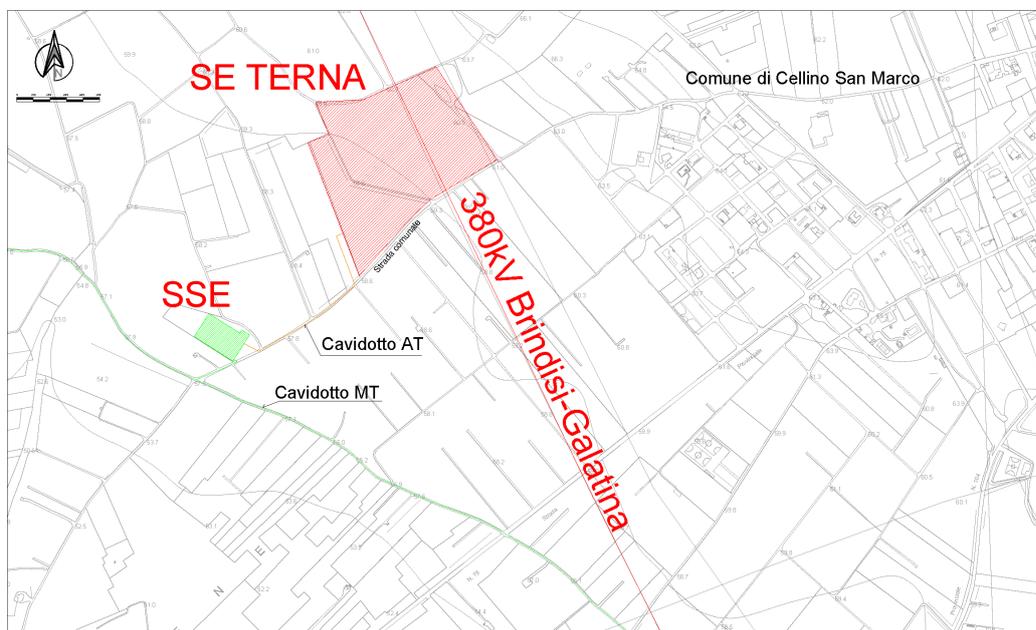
Area SSE (Appia San Marco – area in verde)- In rosso area futura Stazione elettrica Terna
